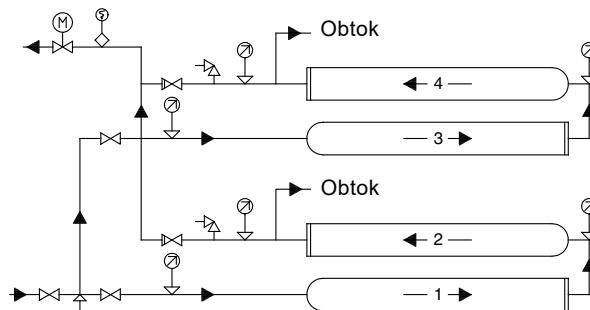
Systém pro zvyšování tlaku se čtyřmi sériově zapojenými moduly umístěnými nad sebou.
